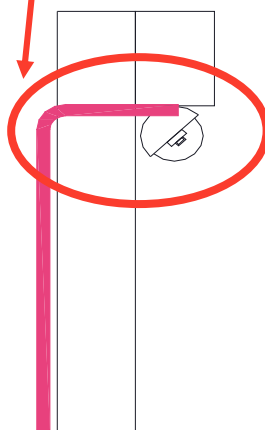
Particolare in installazione apparecchio illuminante - griglia di protezione passerella
